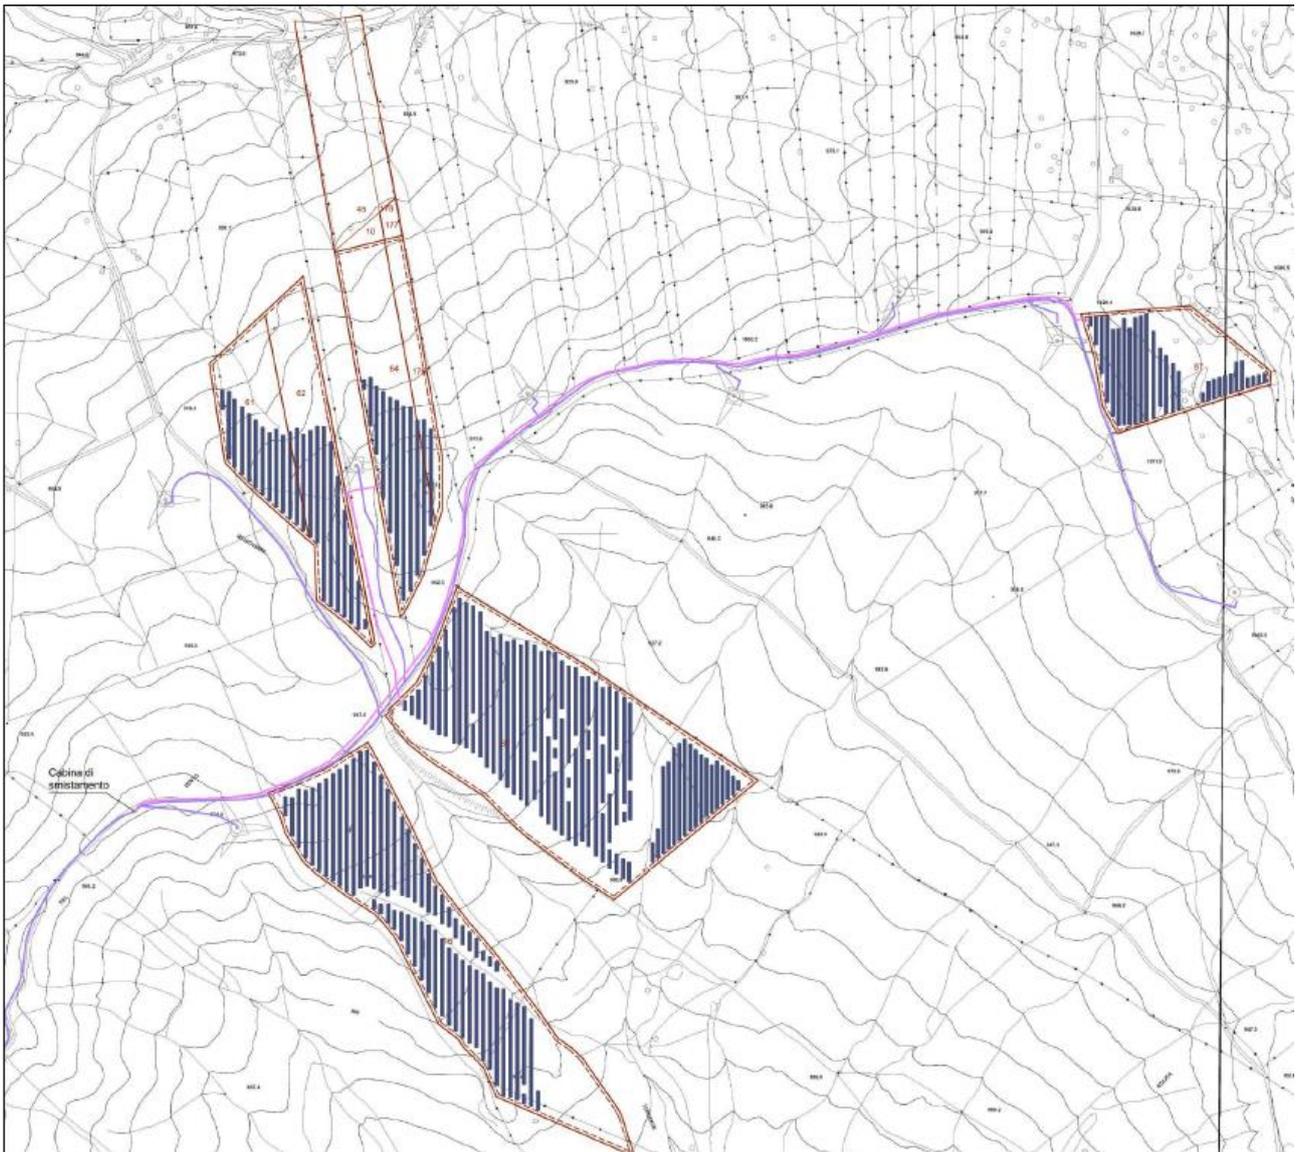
Layout dell'impianto - stralcio Studio di Impatto Ambientale
